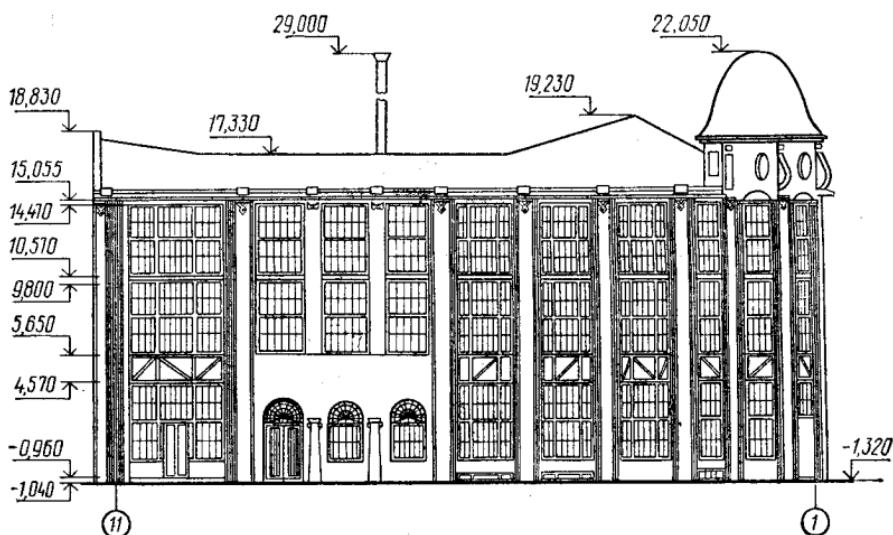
Фасад реконструированного здания Харьковского художественно-производственного комбината
